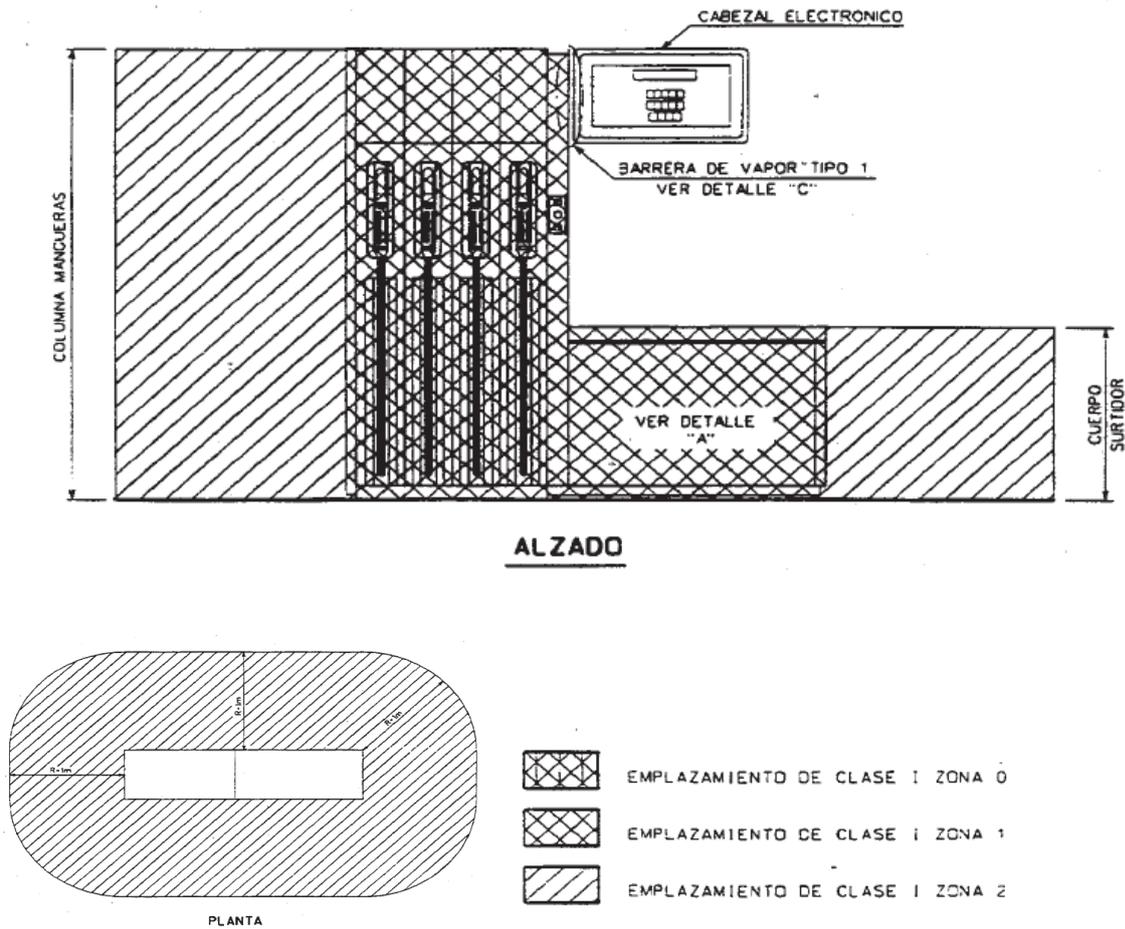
Detalle de las zonas clasificadas en un surtidor con cabezal electrónico elevado y adosado a la columna de mangueras.
